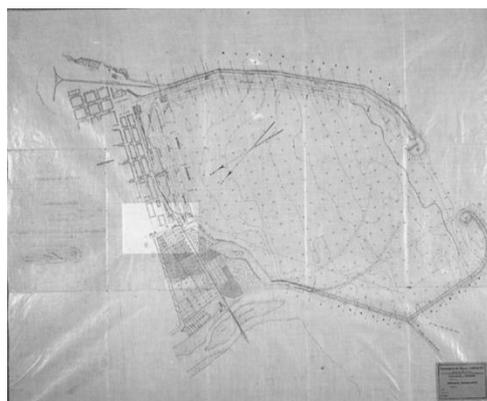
Plano del puerto proyectado por José Álvarez. 1863.
